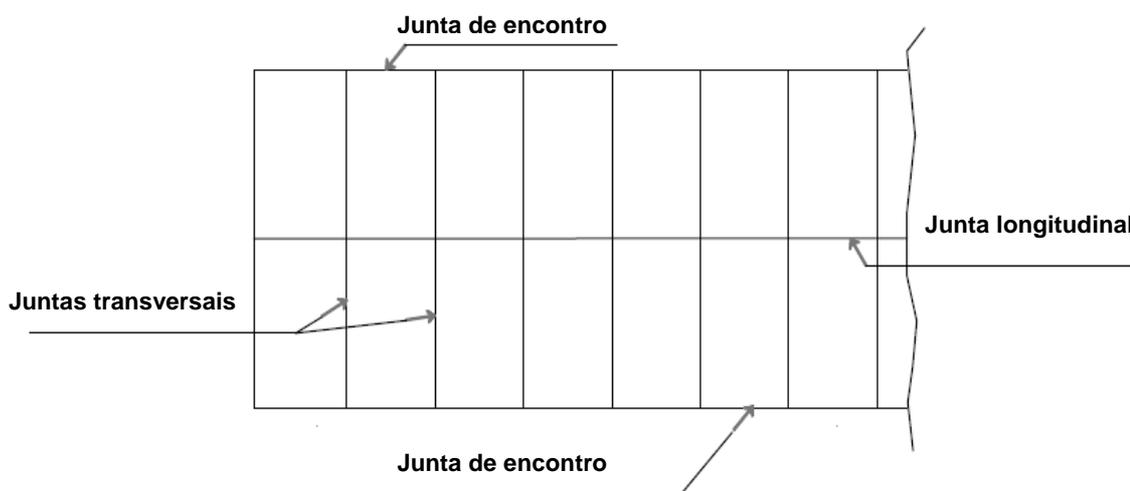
Tipo de juntas de pavimentos industriais de betão.
